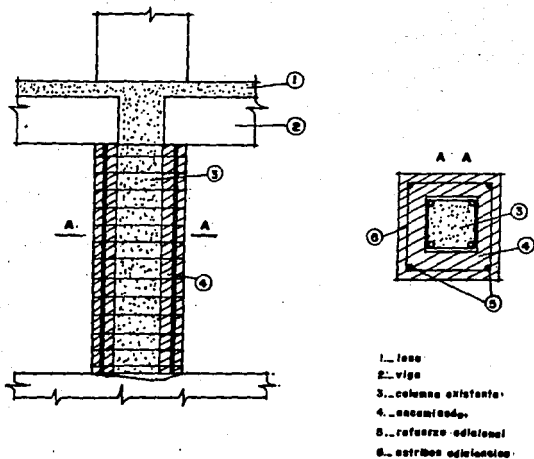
Encamisado de columnas con concreto reforzado (Ref.15)
